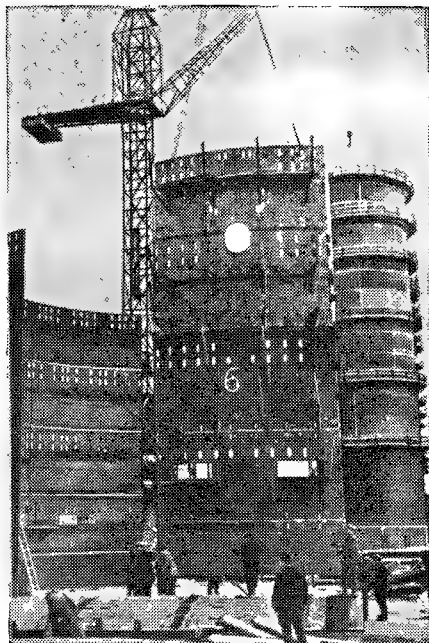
Подъем скорлупы кожуха горна после ее укрупнения электрошлаковой сваркой при вертикальном положении кольцевых швов
